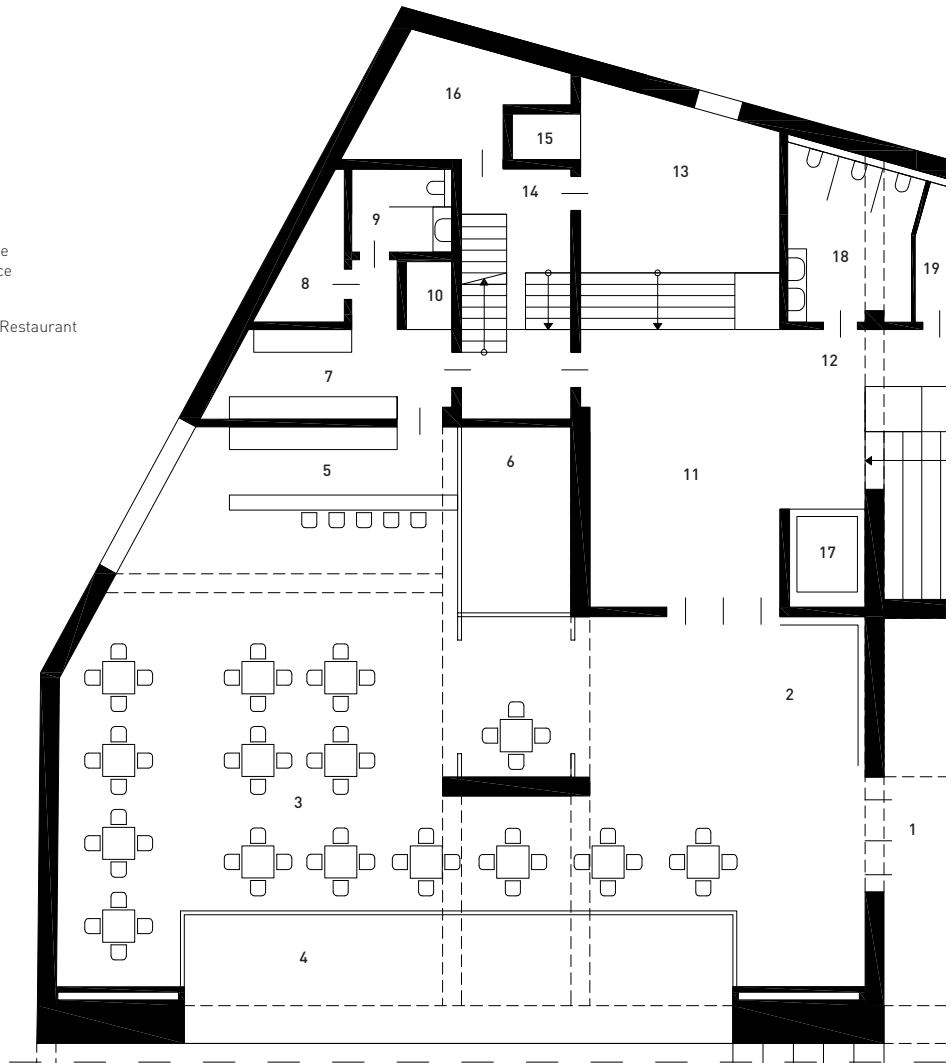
Grundriss Kaffee +1,00m M1:200
